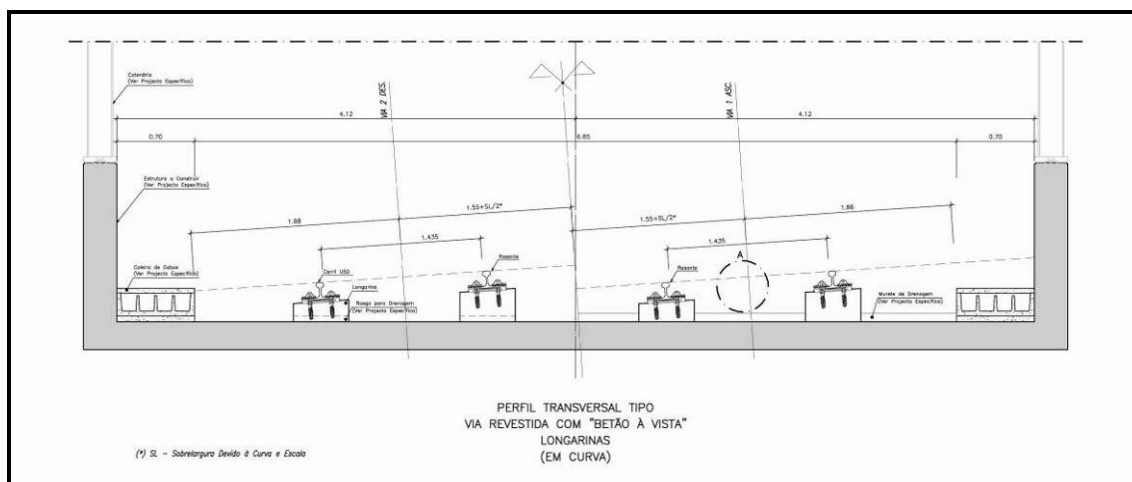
Perfil Transversal Tipo Via Revestida com "Betão à Vista"
